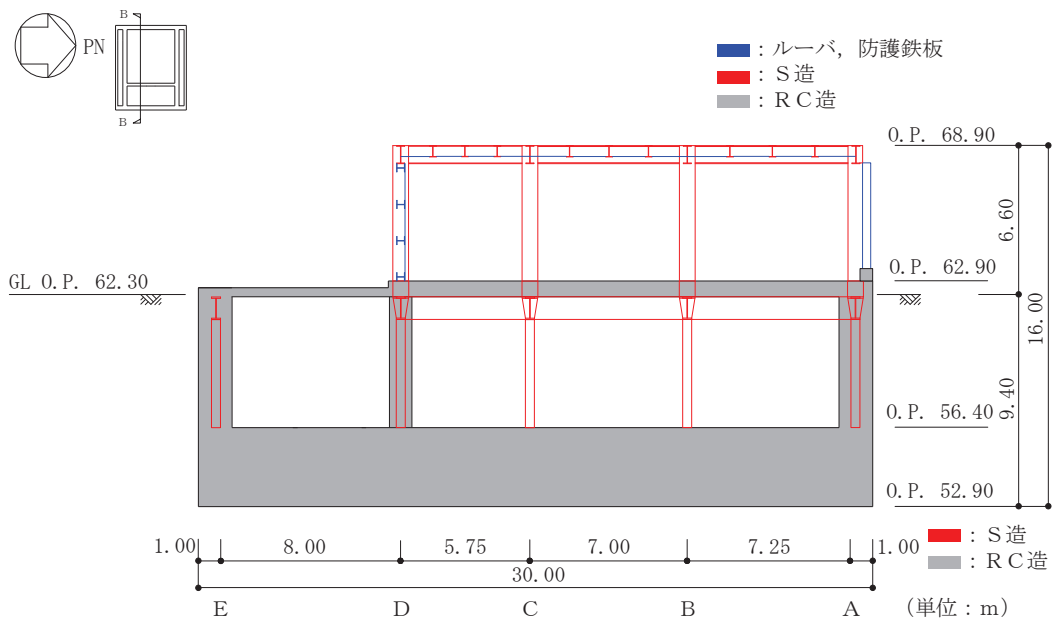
(2) 緊急用電気品建屋の概略断面図 (B-B 断面, EW 方向)
